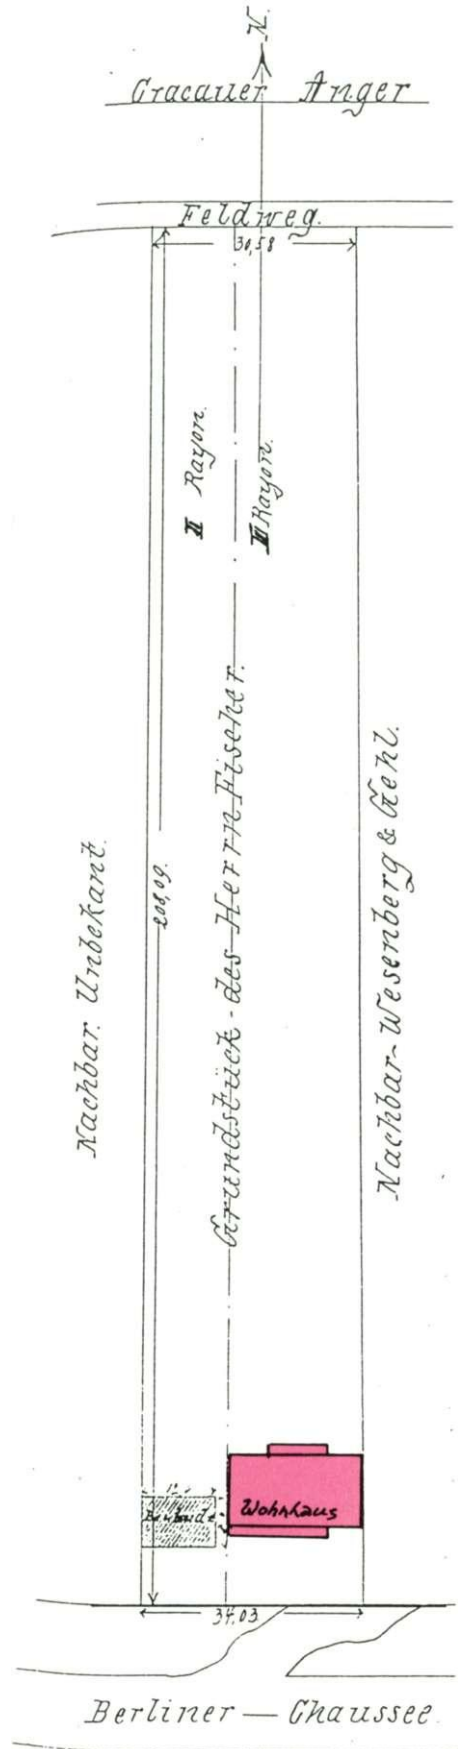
1891. Berliner Chaussee 71: II. und III. Rayon - Bude und Haus.
